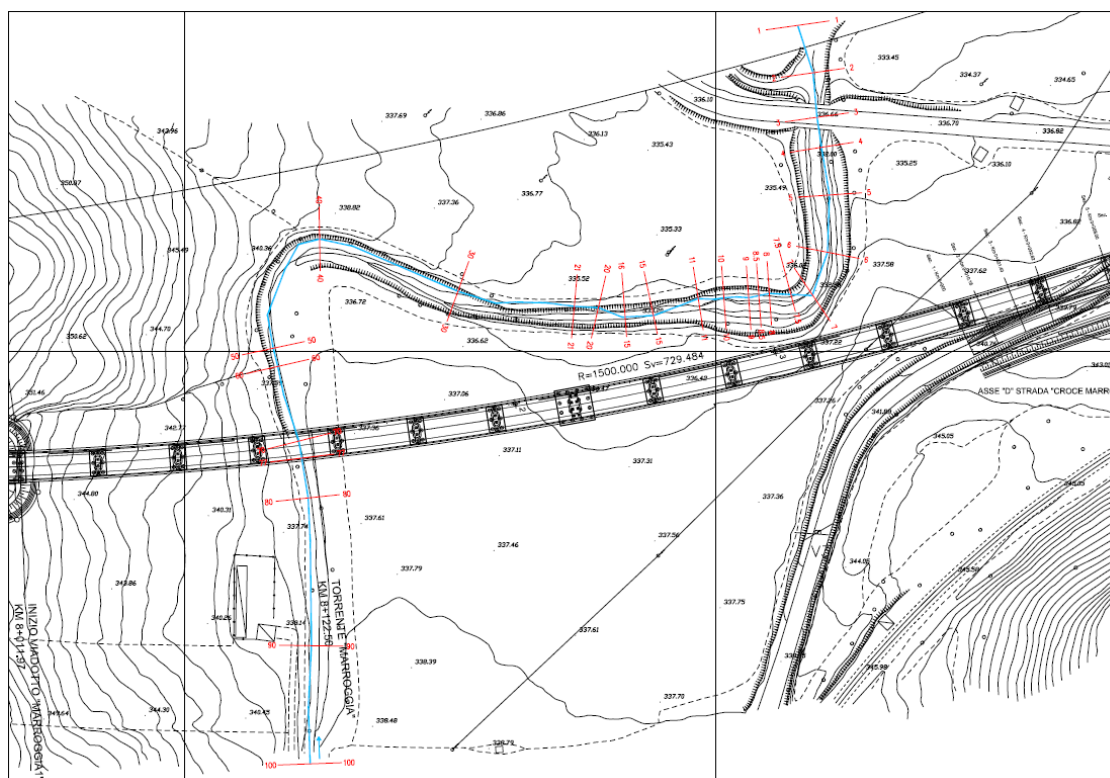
Planimetria e sezioni trasversali d'alveo del Marroggia.
